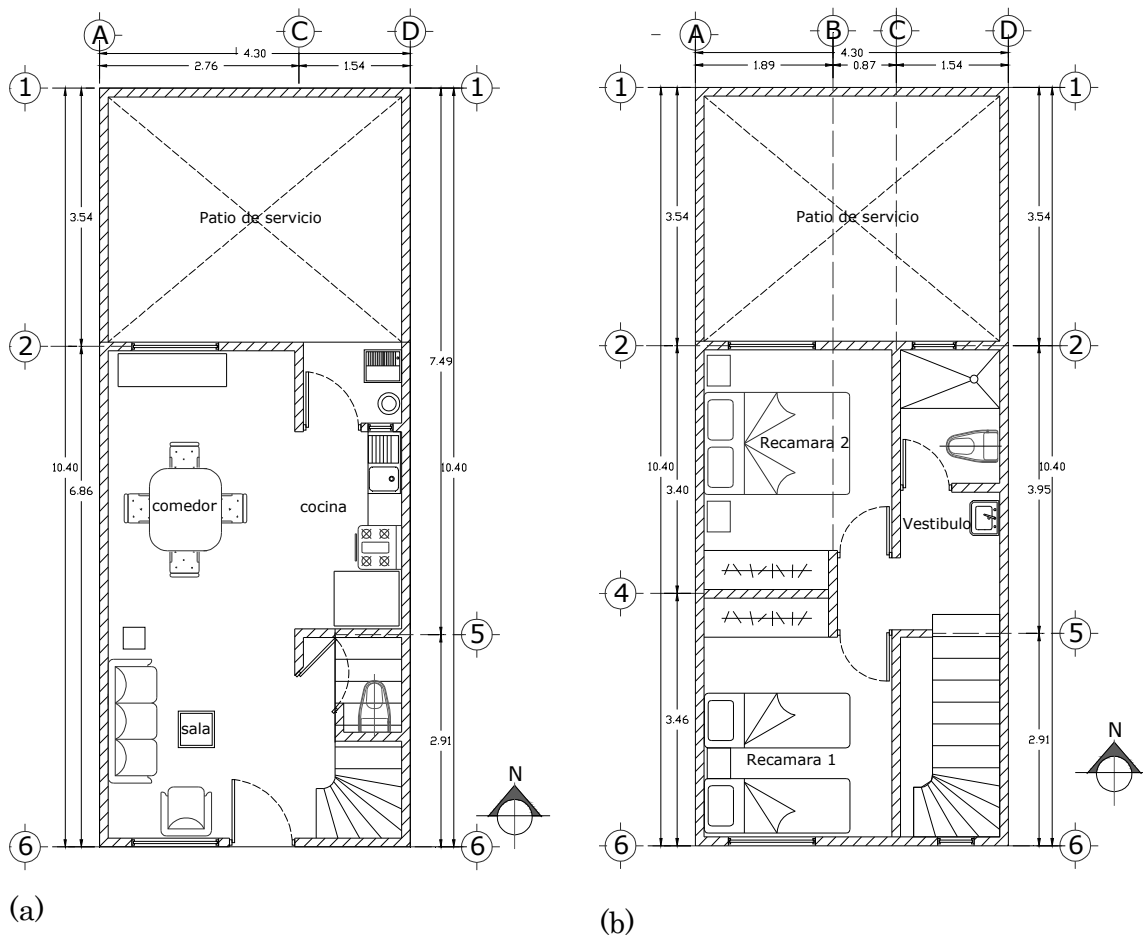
Plantas arquitectónicas del prototipo de estudio. (a) Planta baja, (b) Planta alta.
